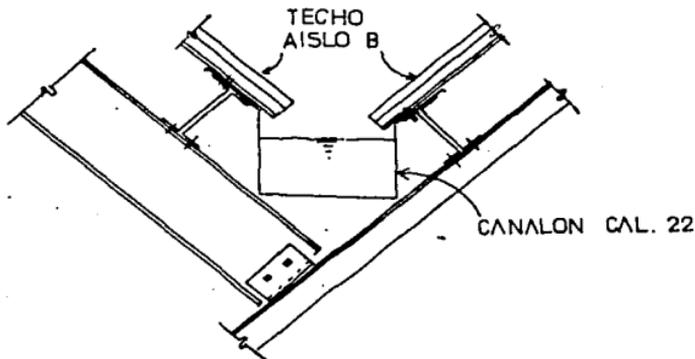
DETALLE DE UNION DE OFICINAS Y EL HANGAR EXISTENTE
